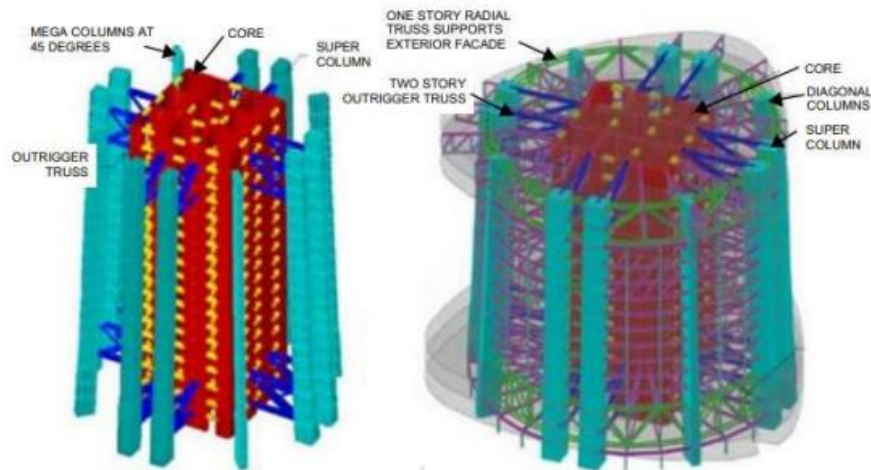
Shanghai Tower, outrigger system - corte de la estructura central del edificio (izquierda) corte de una zona que incorpora losas de piso (derecha),
